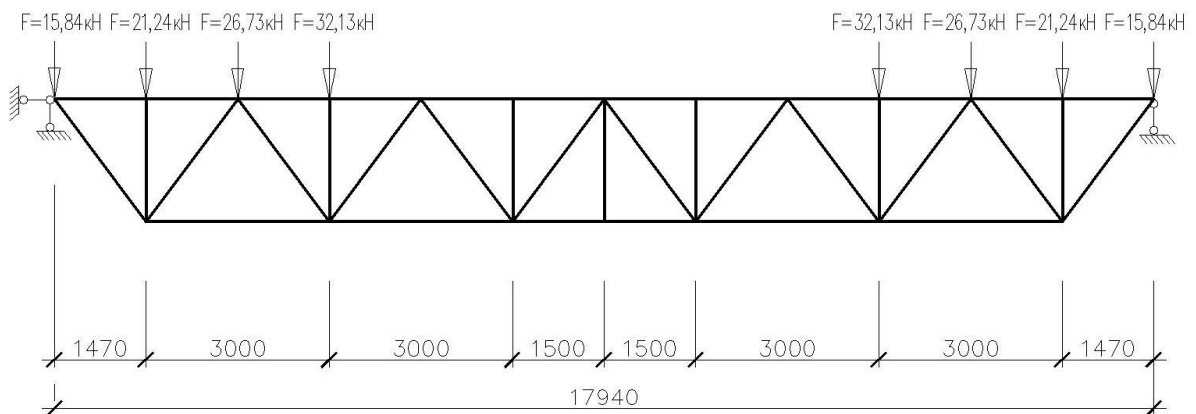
Схема приложенных снеговых нагрузок на ферму ФС
